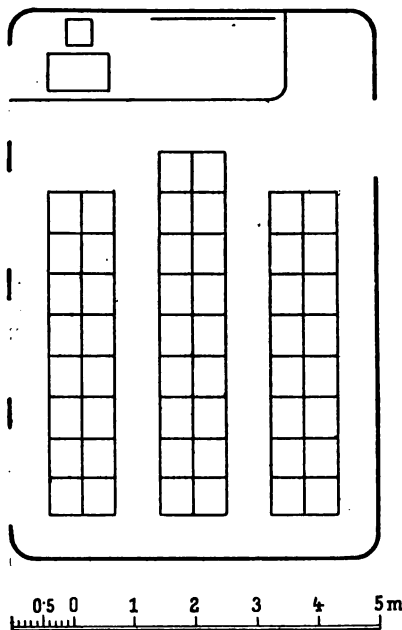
Grundriss eines Schulzimmers mit zweifelhigen Bänken für 50 Schüler.
